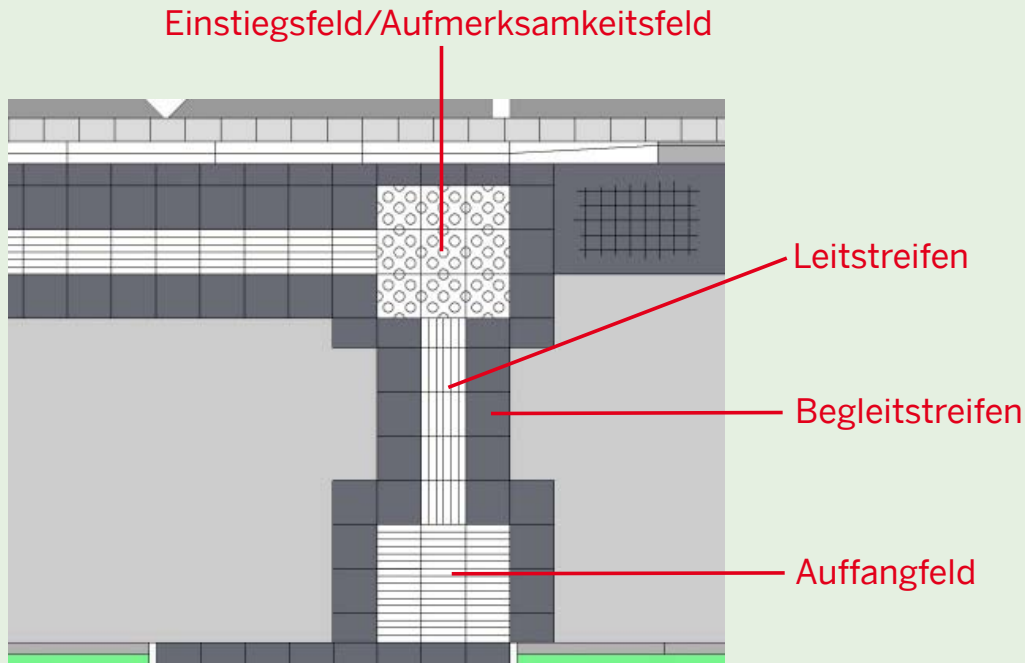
Auffangfeld bei gemeinsamen Rad-/Gehwegen
